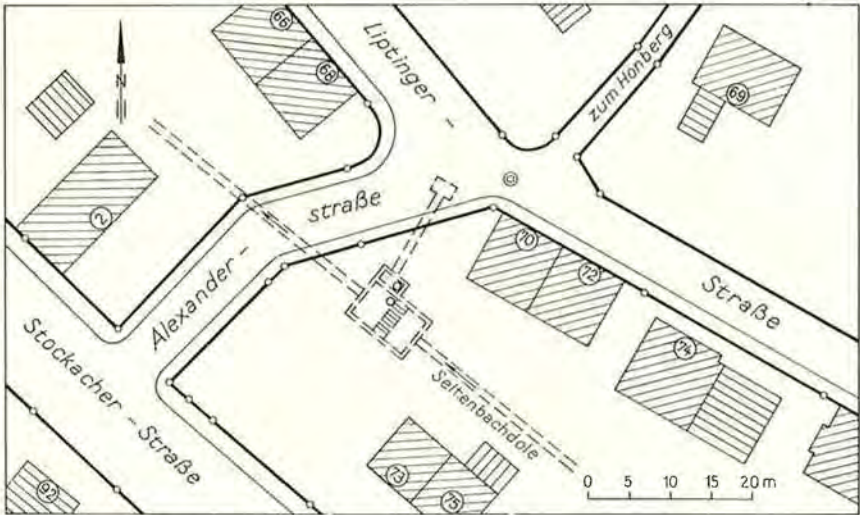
Lageplan der Einspeisestelle H für das Steinsalz im südlichen Stadtgebiet Tuttingen.
